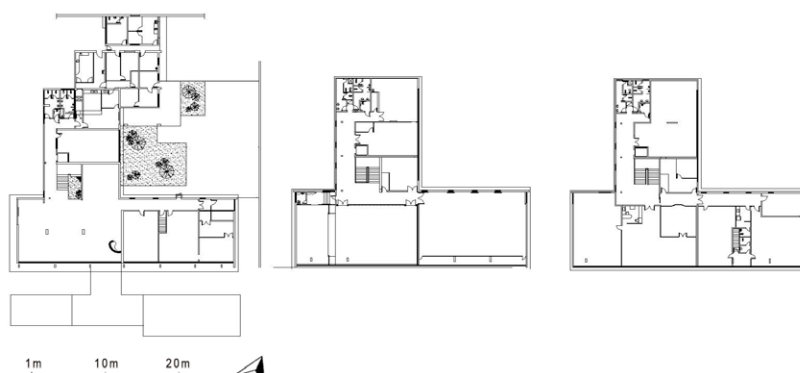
| Planta dos 1º, 2º e 3º pavimentos do MAMM, mostrando as salas expositivas e a configuração espacial da arquitetura.
